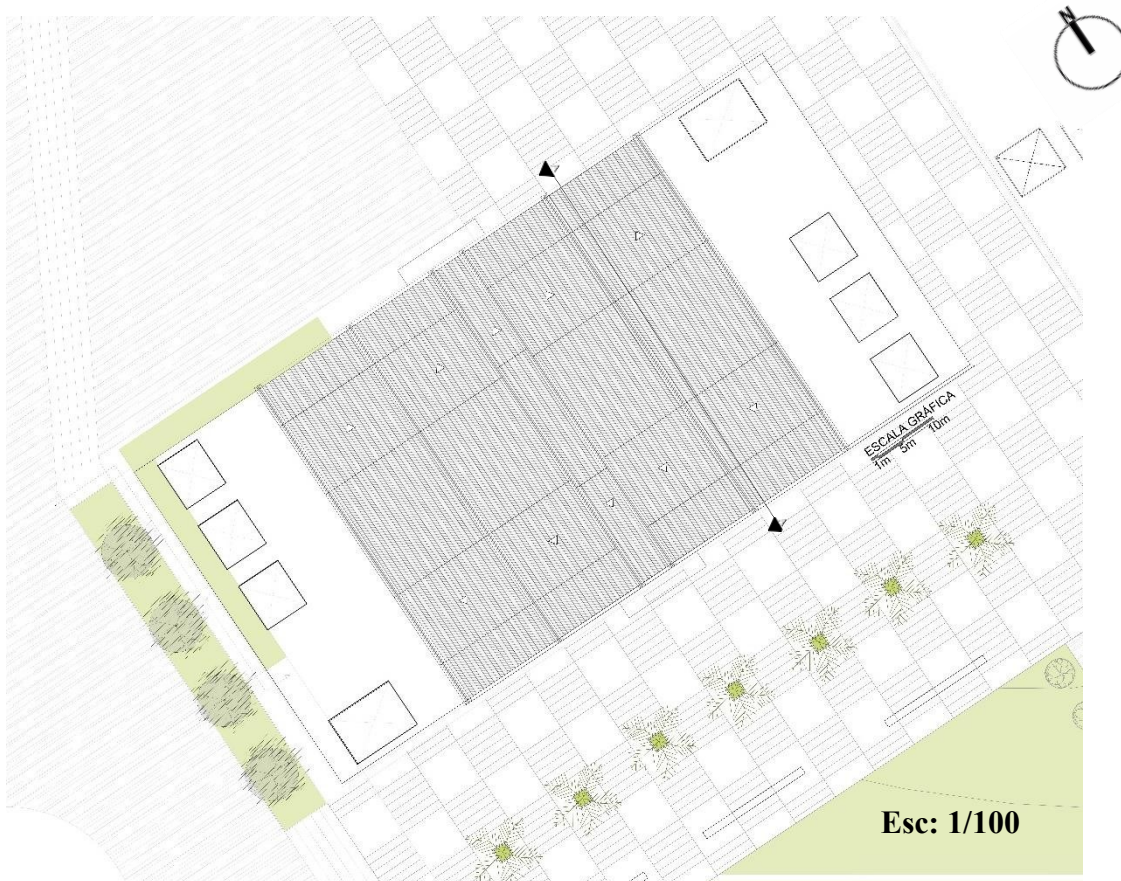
Planta de cubiertas Escenario Múltiple Voley-Basquet
